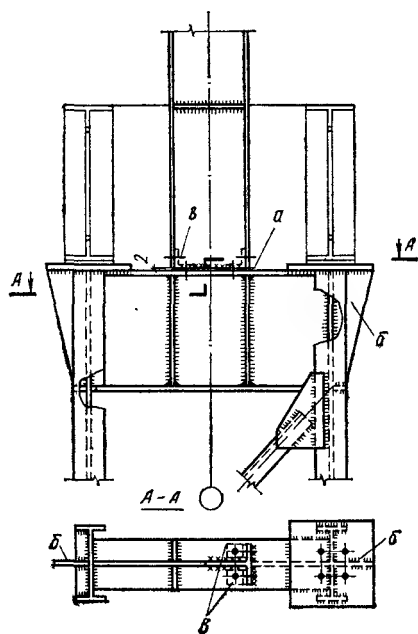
Вариант сопряжения надкрановой и подкрановой частей ступенчатой колонны среднего ряда
